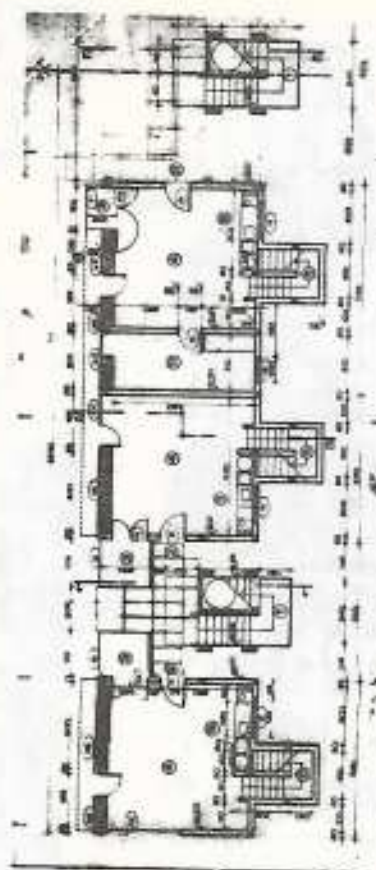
Plantas niveles +2.85 y +8.25 sub-conjunto 3
